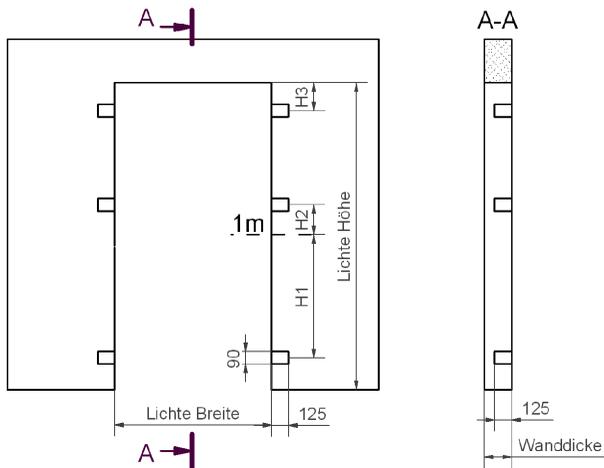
Maßskizze der Ankerassparungen (Betonwand und Mauerwerk)
